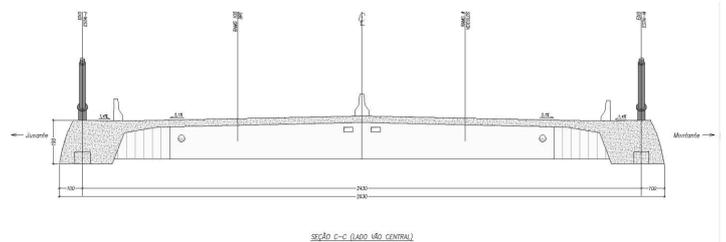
Sezione trasversale dell’impalcato / Deck cross section
